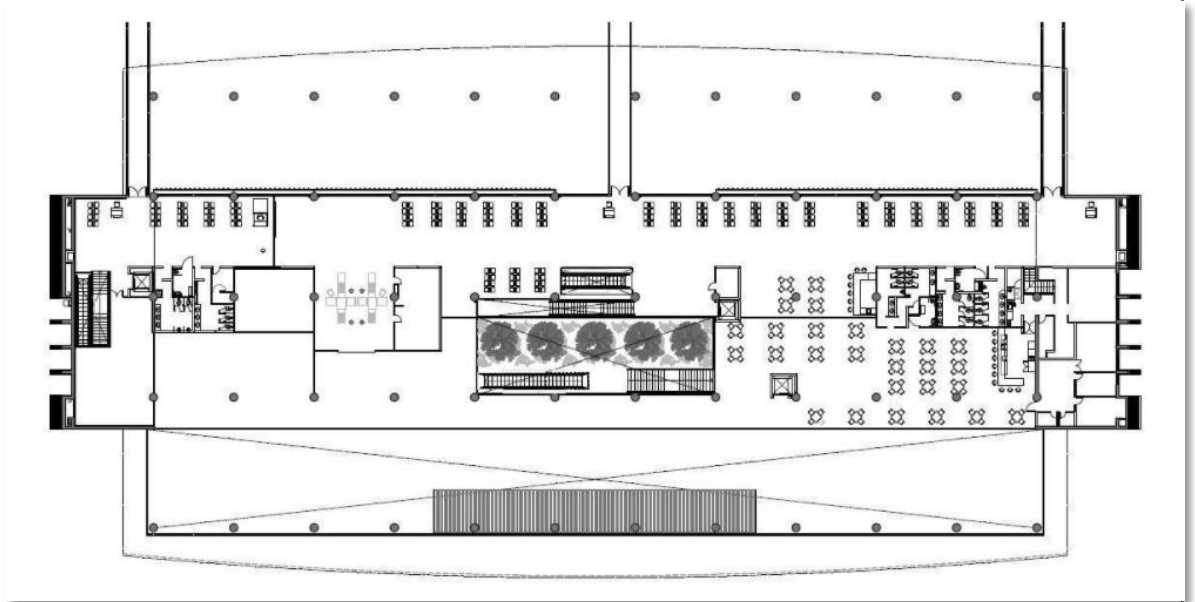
Aeropuerto de la Araucanía, Temuco, Chile – Plano de planta alta. Fuente:
